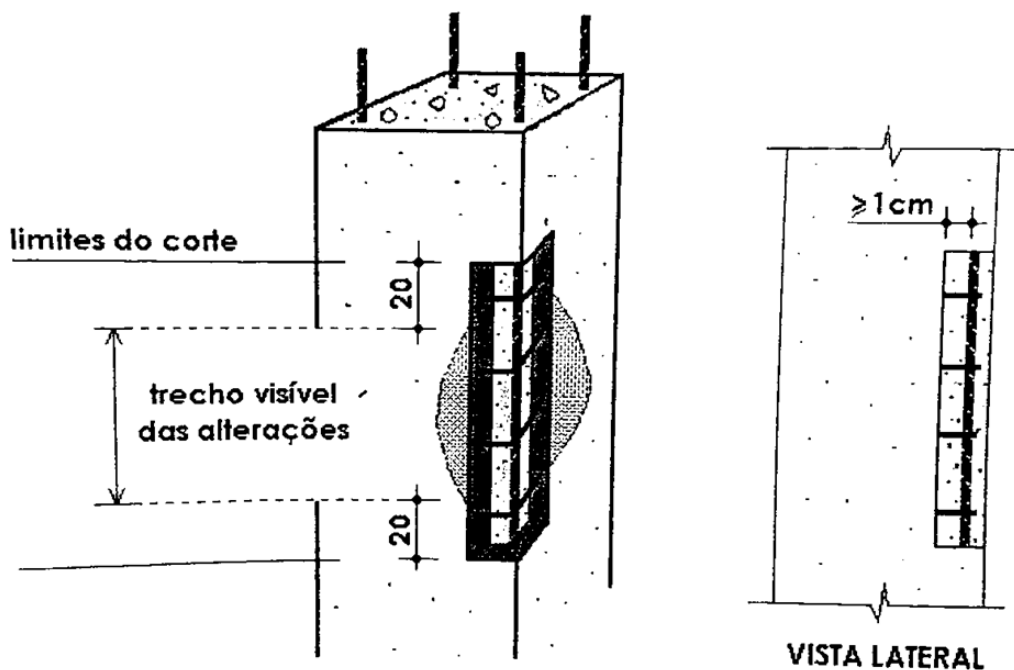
Delimitação da região de reparo de armadura corroída (IPT, 2007).
